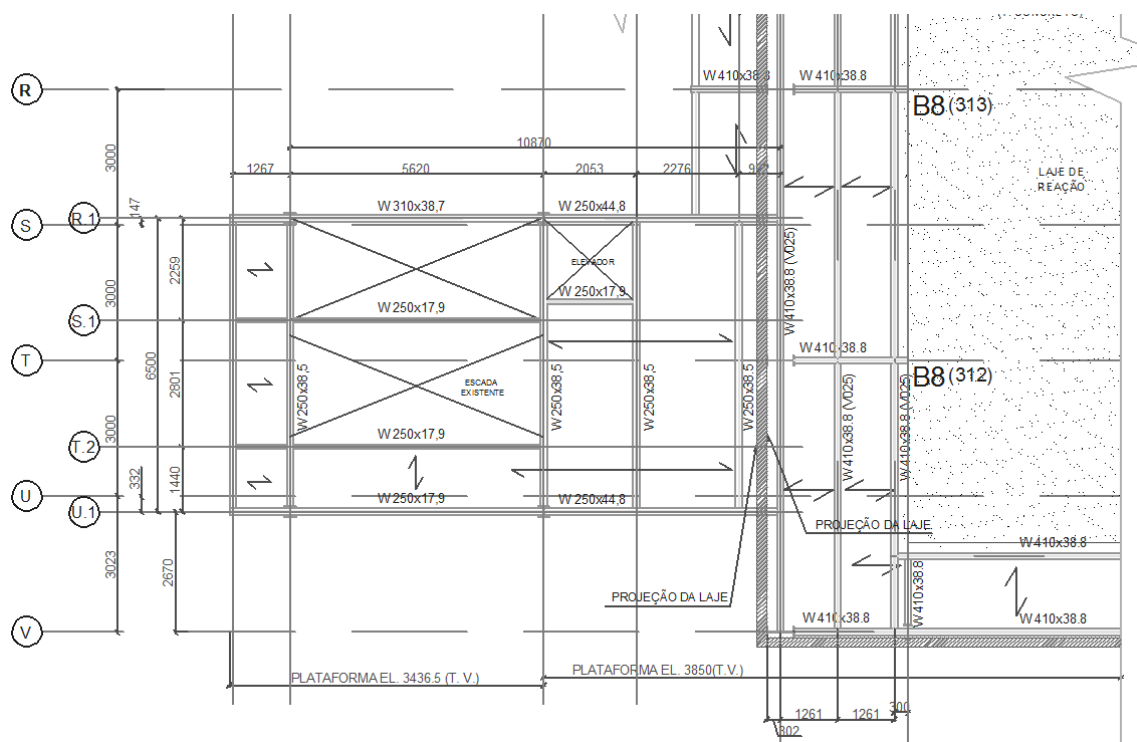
Planta de Elevação Níveis +7186,5 a +7650.
